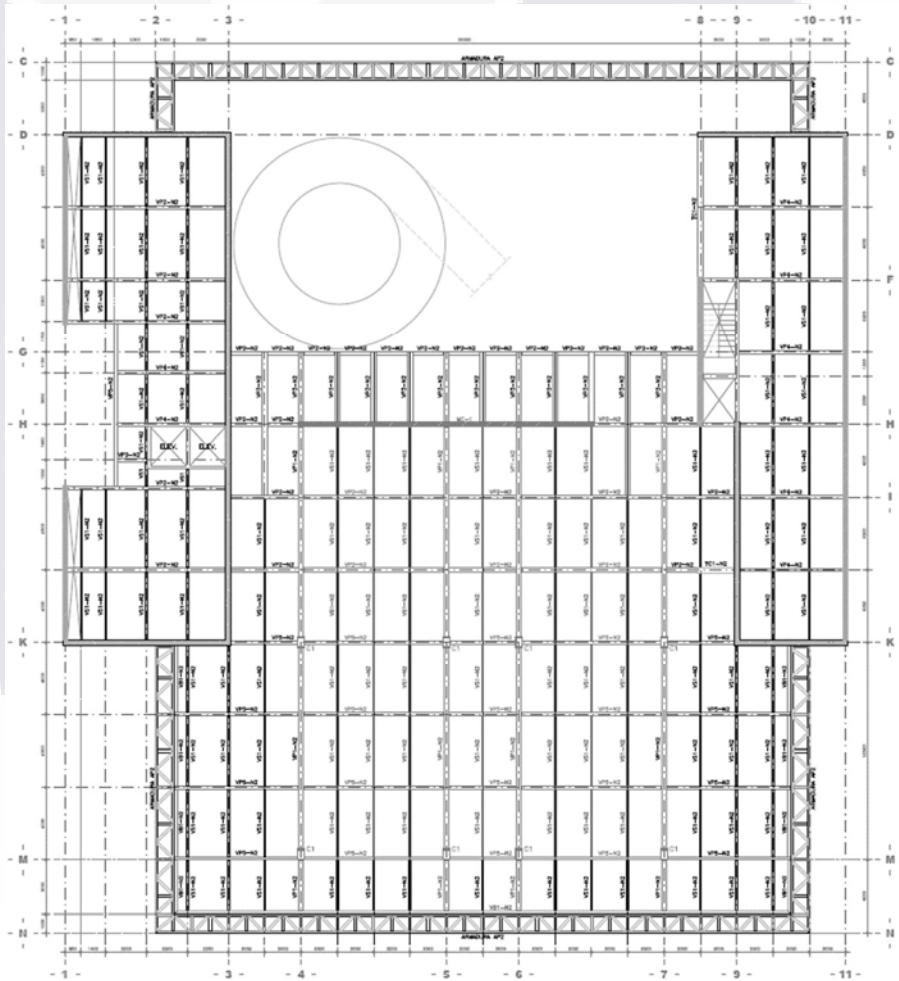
Planta estructural del salón de usos múltiples. Fuente: Elaboración propia.
